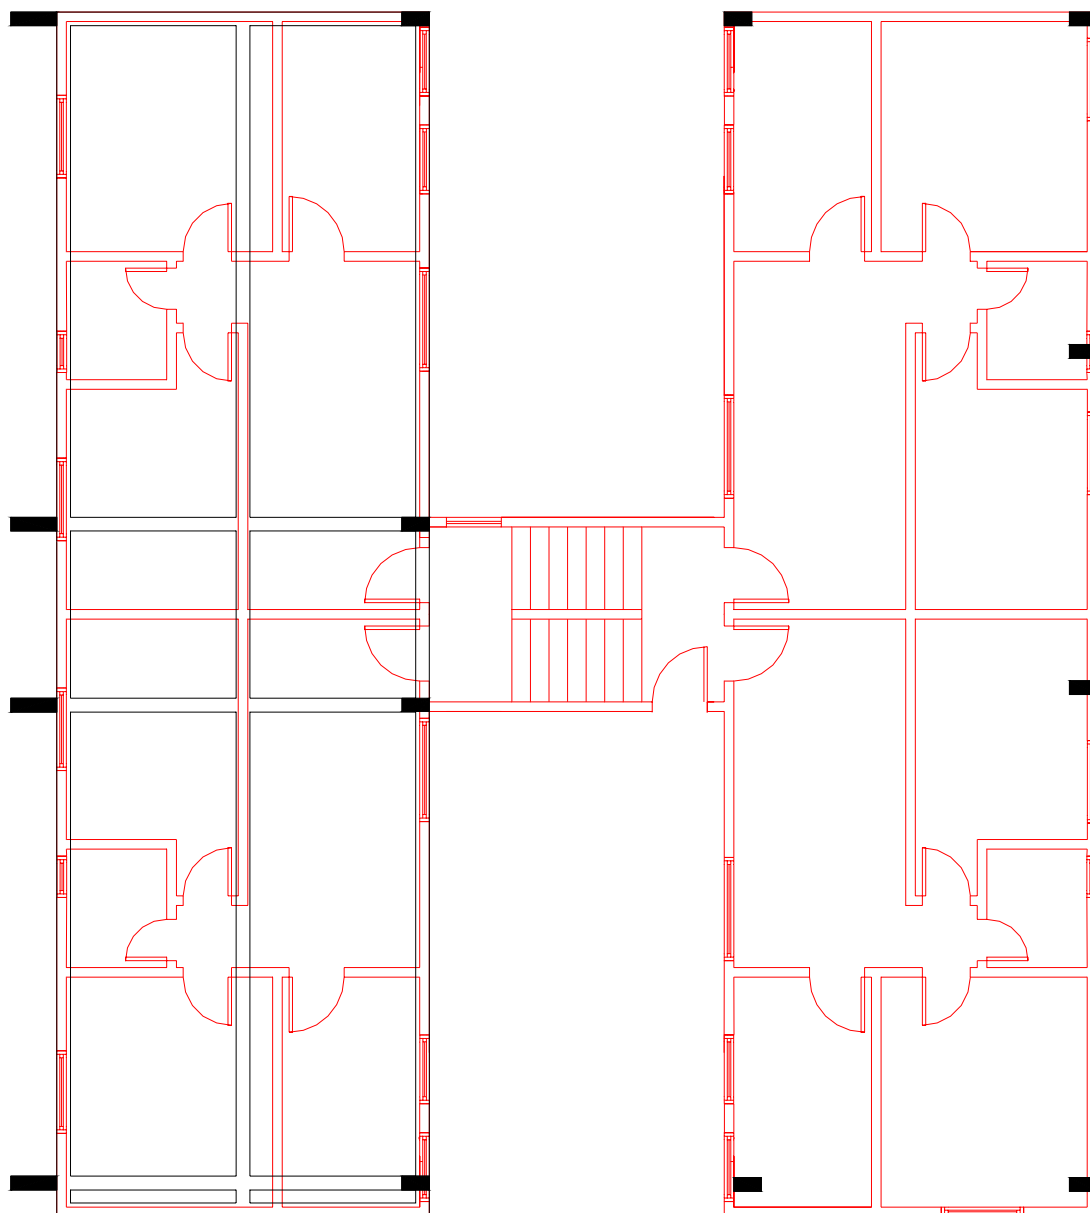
Residencial “J” – Bloco 4 – Superposição das alvenarias do pavimento tipo sobre a primeira solução de vigamento de pilotis
